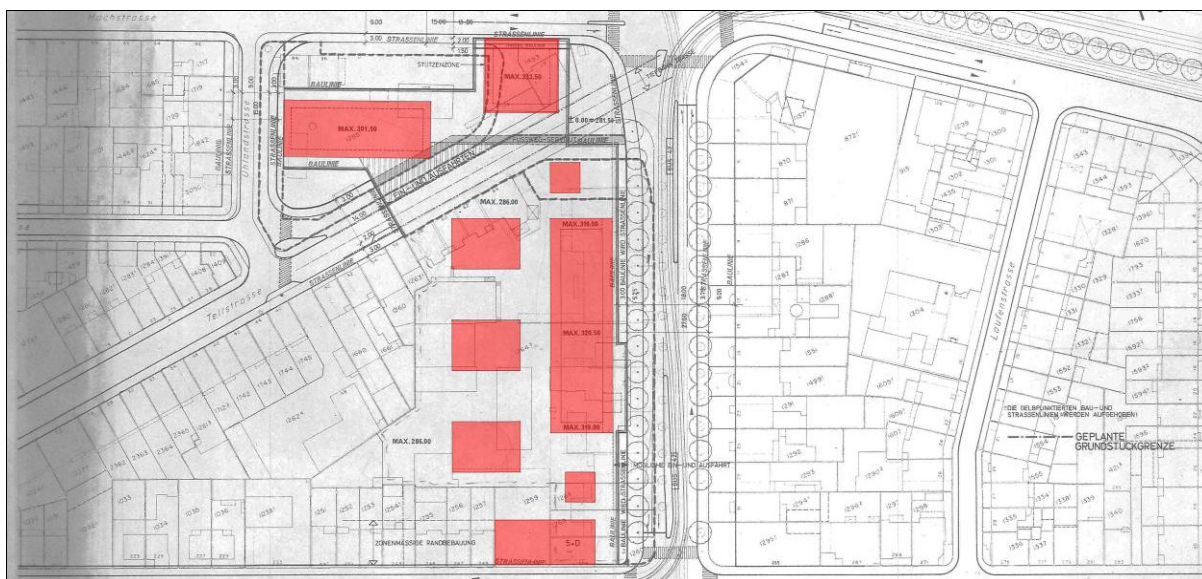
Bebauungsplan Nr. 112, Plan Nr. 9'739 aus dem Jahr 1972
